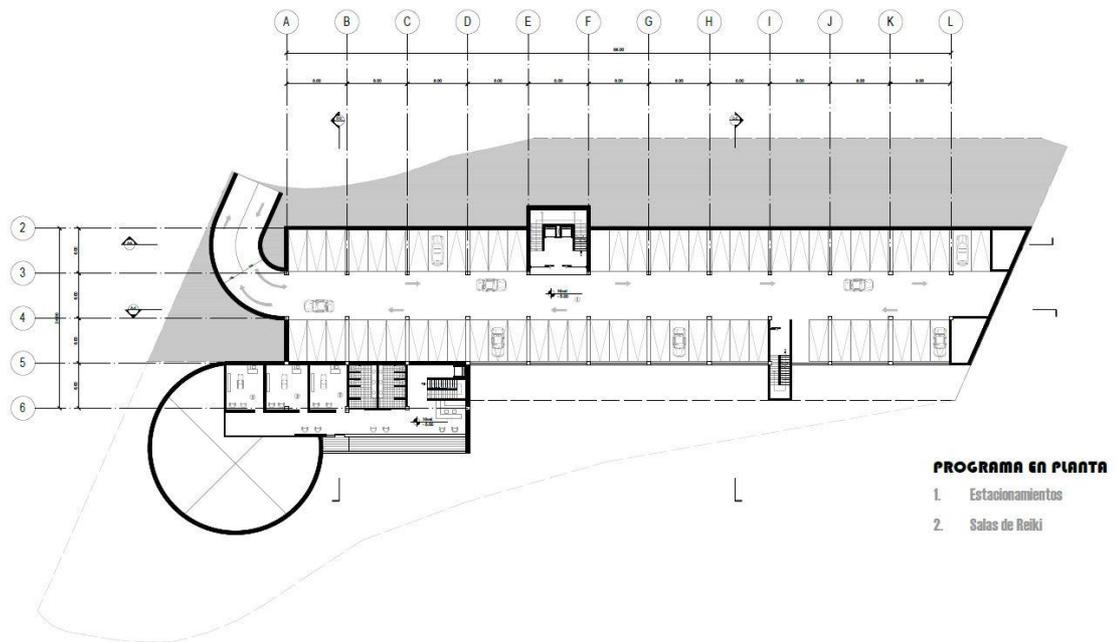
Planta Primera N+ 5.20. Elaboración propia.
